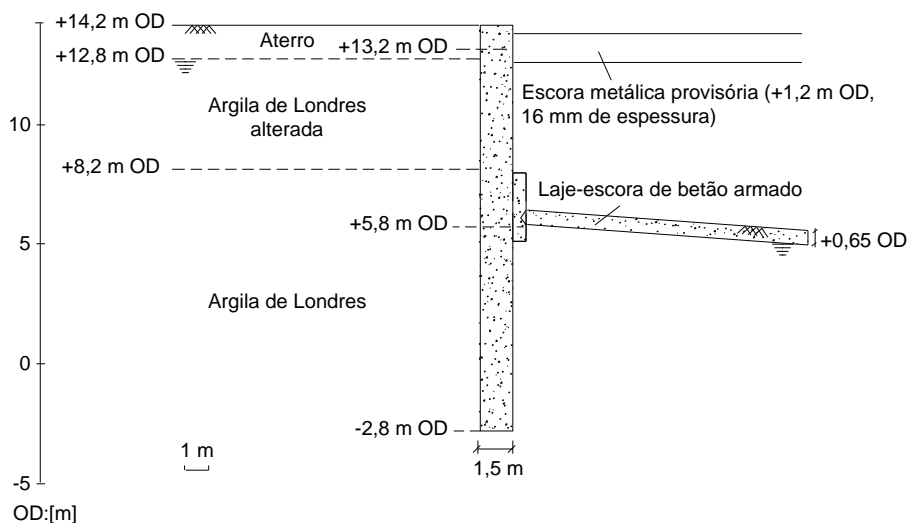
Secção transversal da escavação (adaptado de Watson e Carder, 1994).
